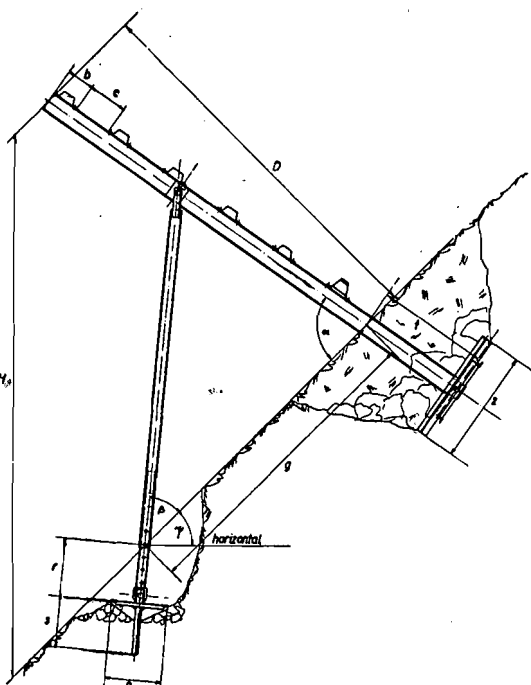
Prinzipzeichnung der Schneebrücken mit Grundplatten
